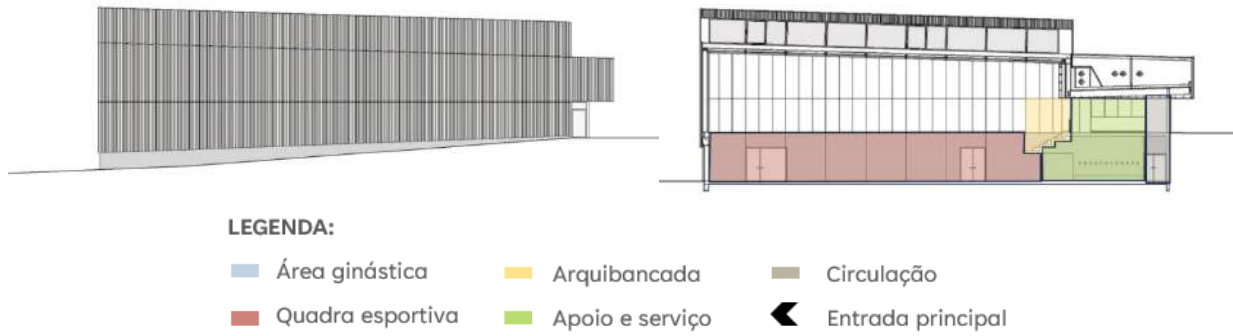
Fachada e corte vista oeste / Fonte: Archdaily
